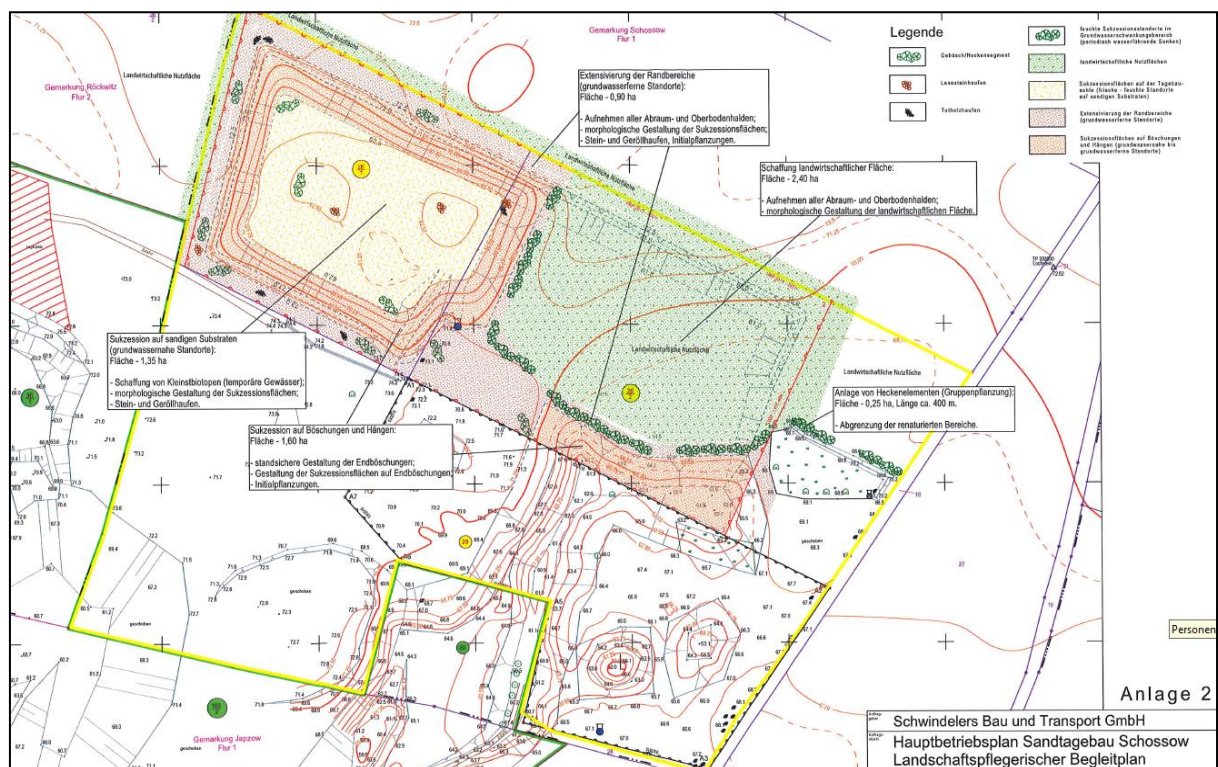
Wiedernutzbarmachungsplan, Auszug des Hauptbetriebsplan Sandtagebau Schossow
